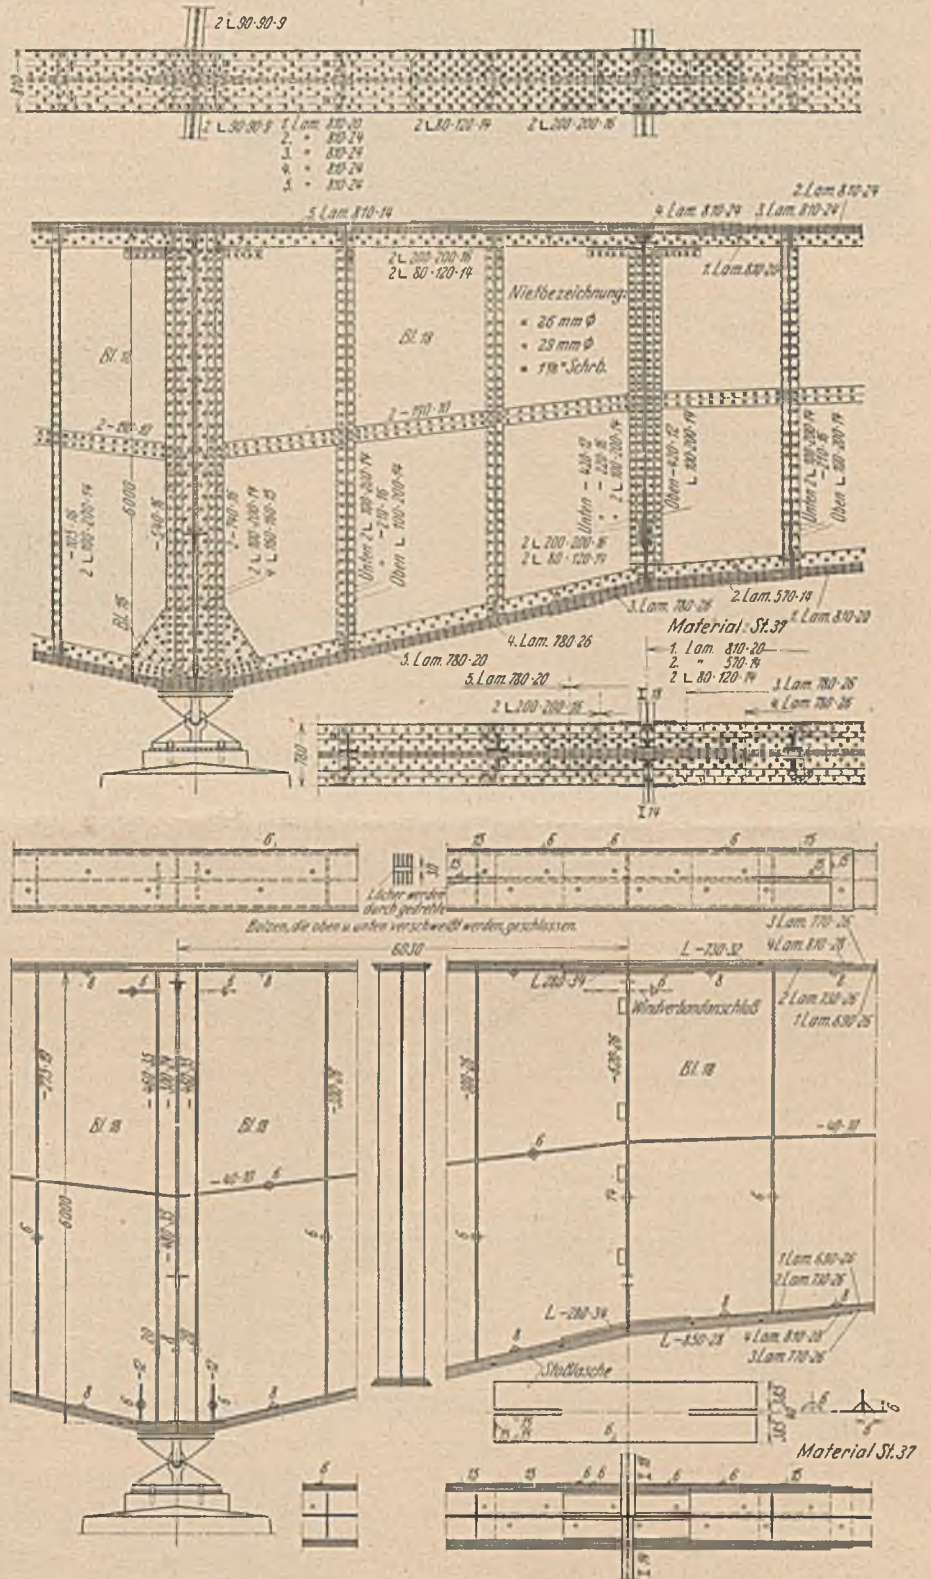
Hauptträger am Strompfeiler. Oben genietet, unten geschweißt.
